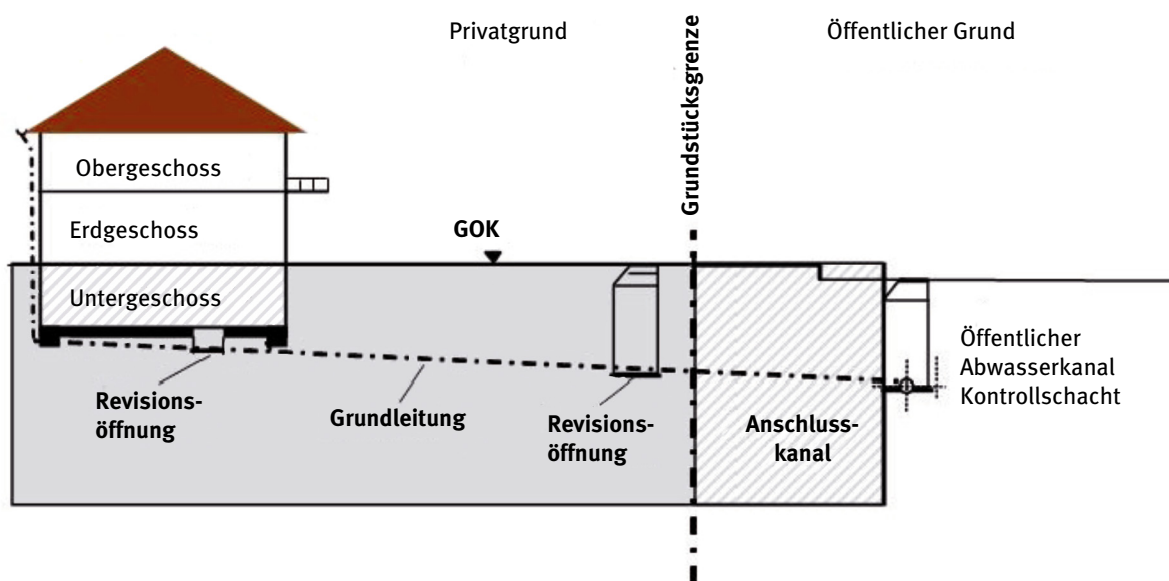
Beschreibung der Grundstücksentwässerungsanlage und Anwendungsbereich des Leitfadens
